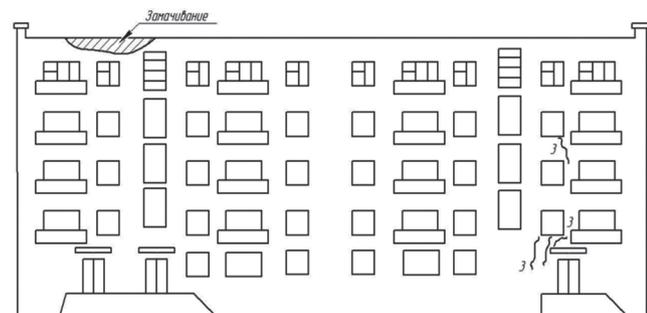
Дом 49. Трещины стены дворового фасада
